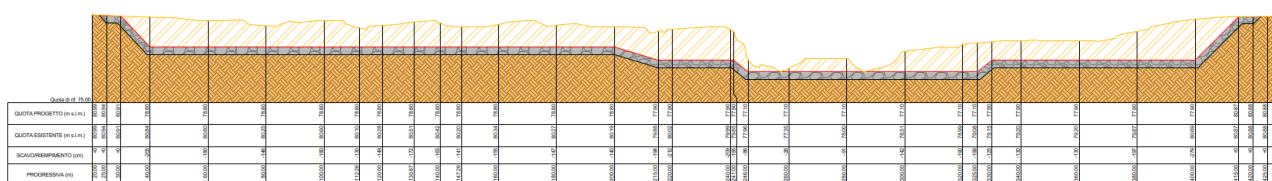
Profilo longitudinale di progetto del pennello. Estratto della tavola PF.0.0.8.PR.GE.S.Z.0.0.2.A.
